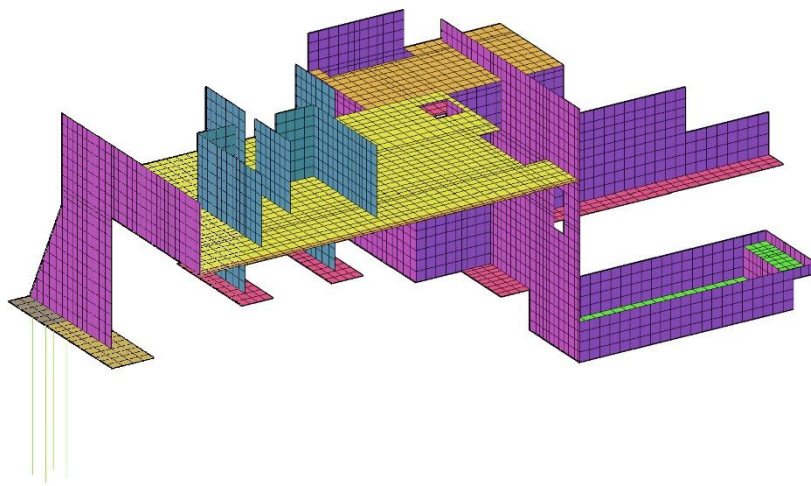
Geometría del modelo en AutoCAD. Planta principal. Fuente: elaboración propia.
